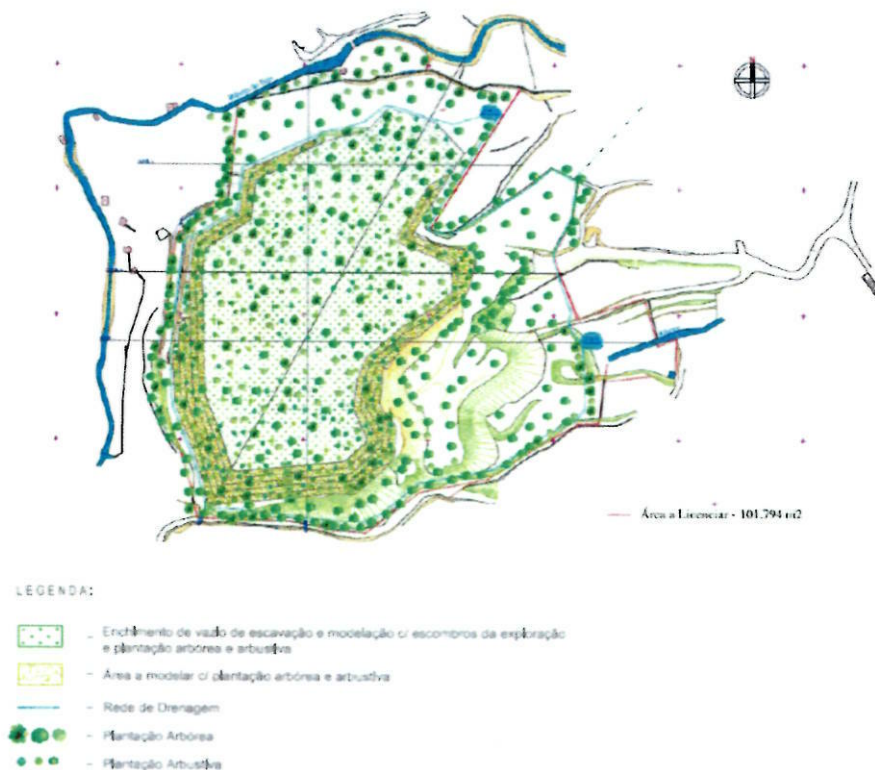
Planta final de recuperação (Fonte: EIA – outubro de 2016).
